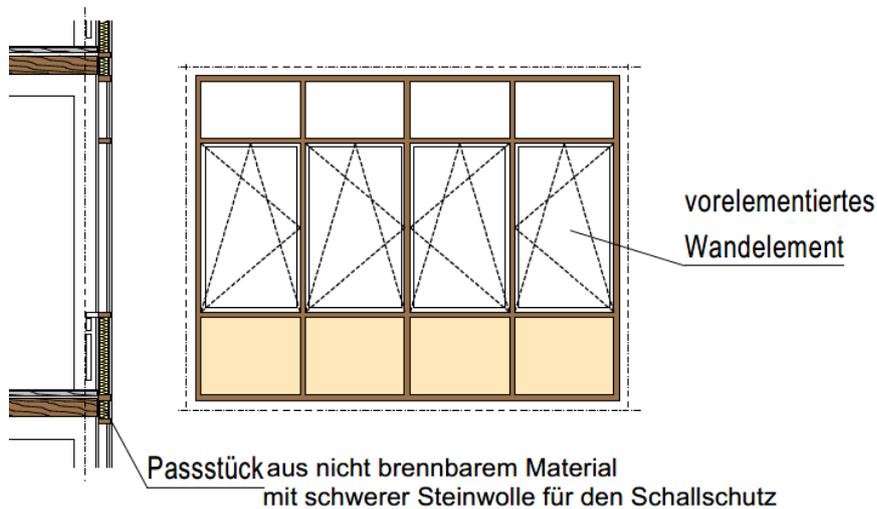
Detailzeichnung Fassade [Triade Architekten]
